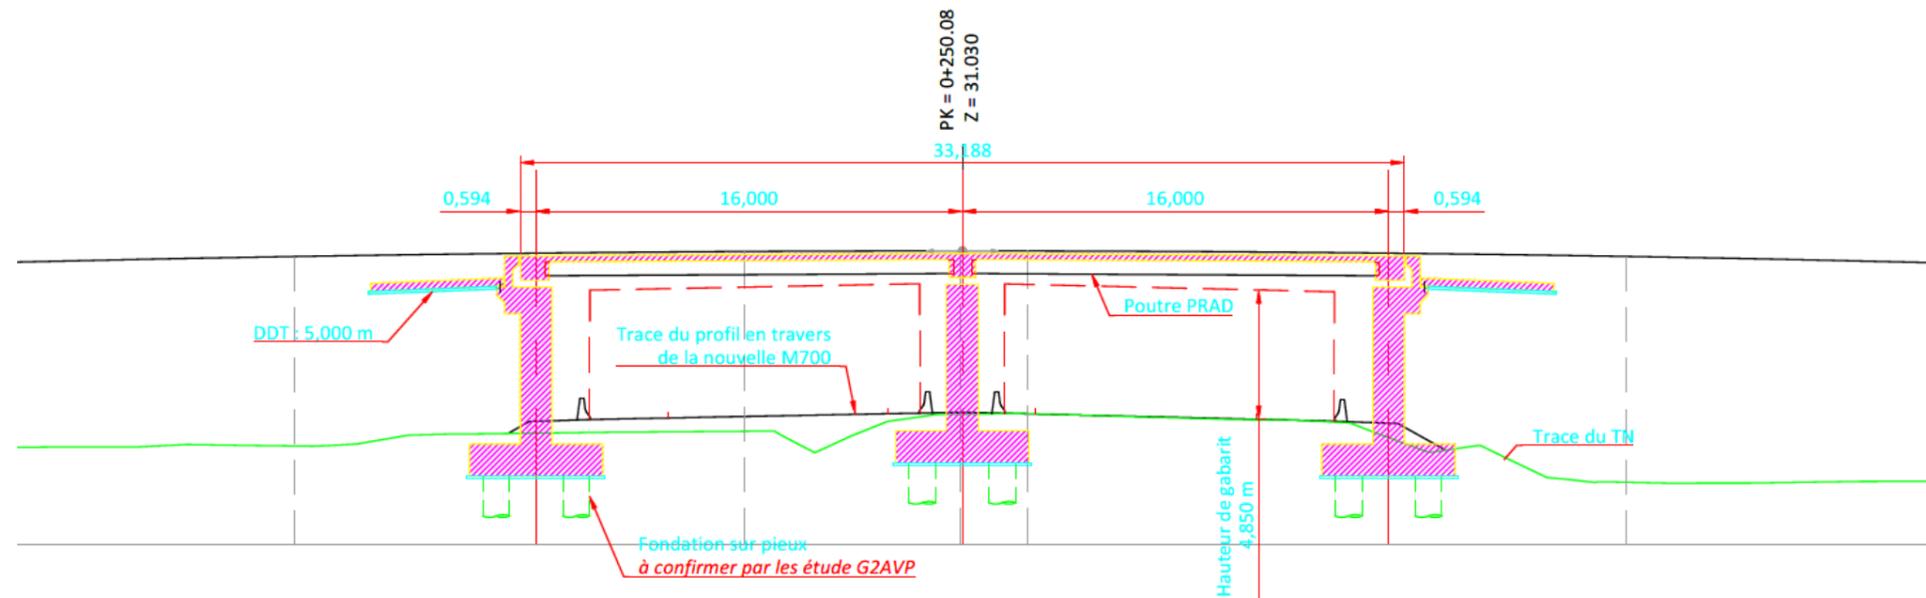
PS1 - Coupe longitudinale de l'ouvrage
